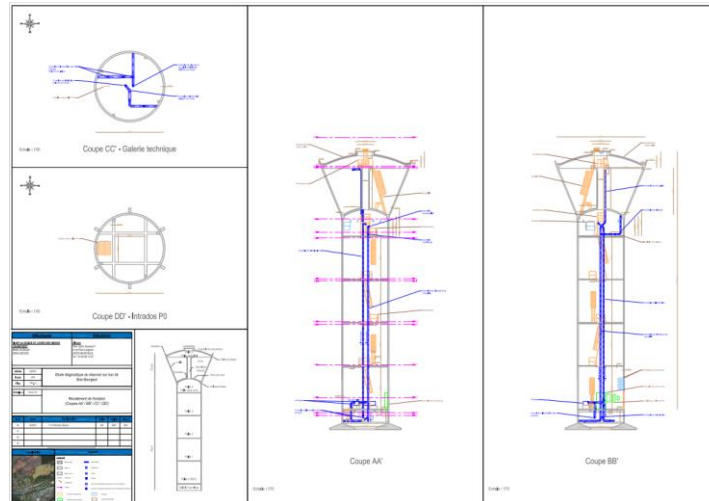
Récolement de l'ouvrage - extrait plan de récolement – Planche 1
